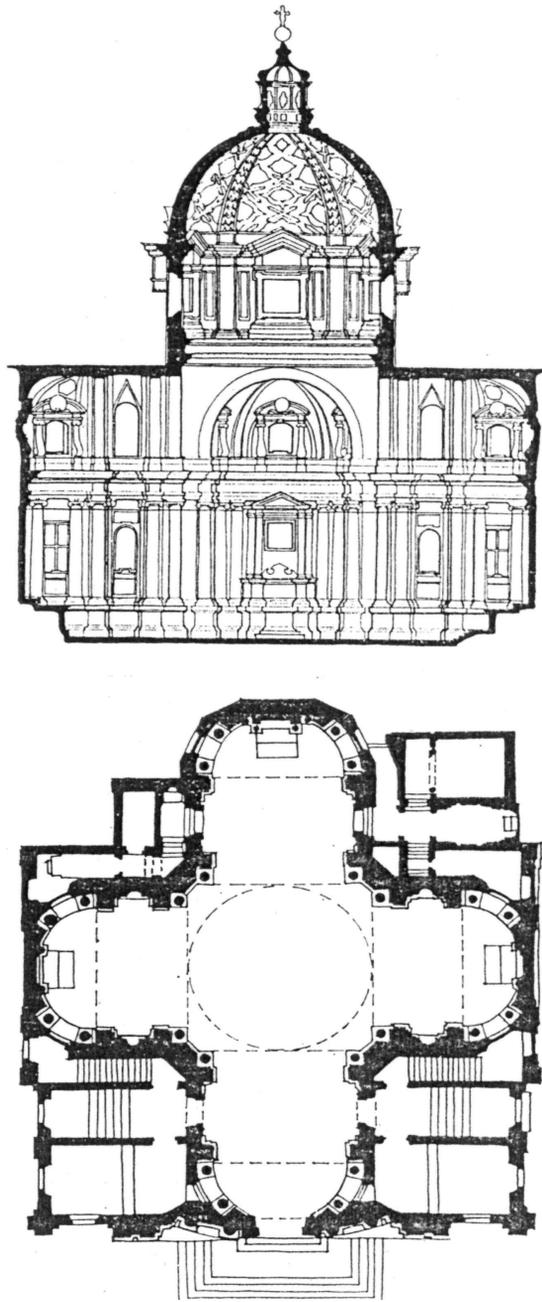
Roma, SS. Martina e Luca: sezione e planimetria (da "Arte e architettura in Italia" - R. Wittkower).
